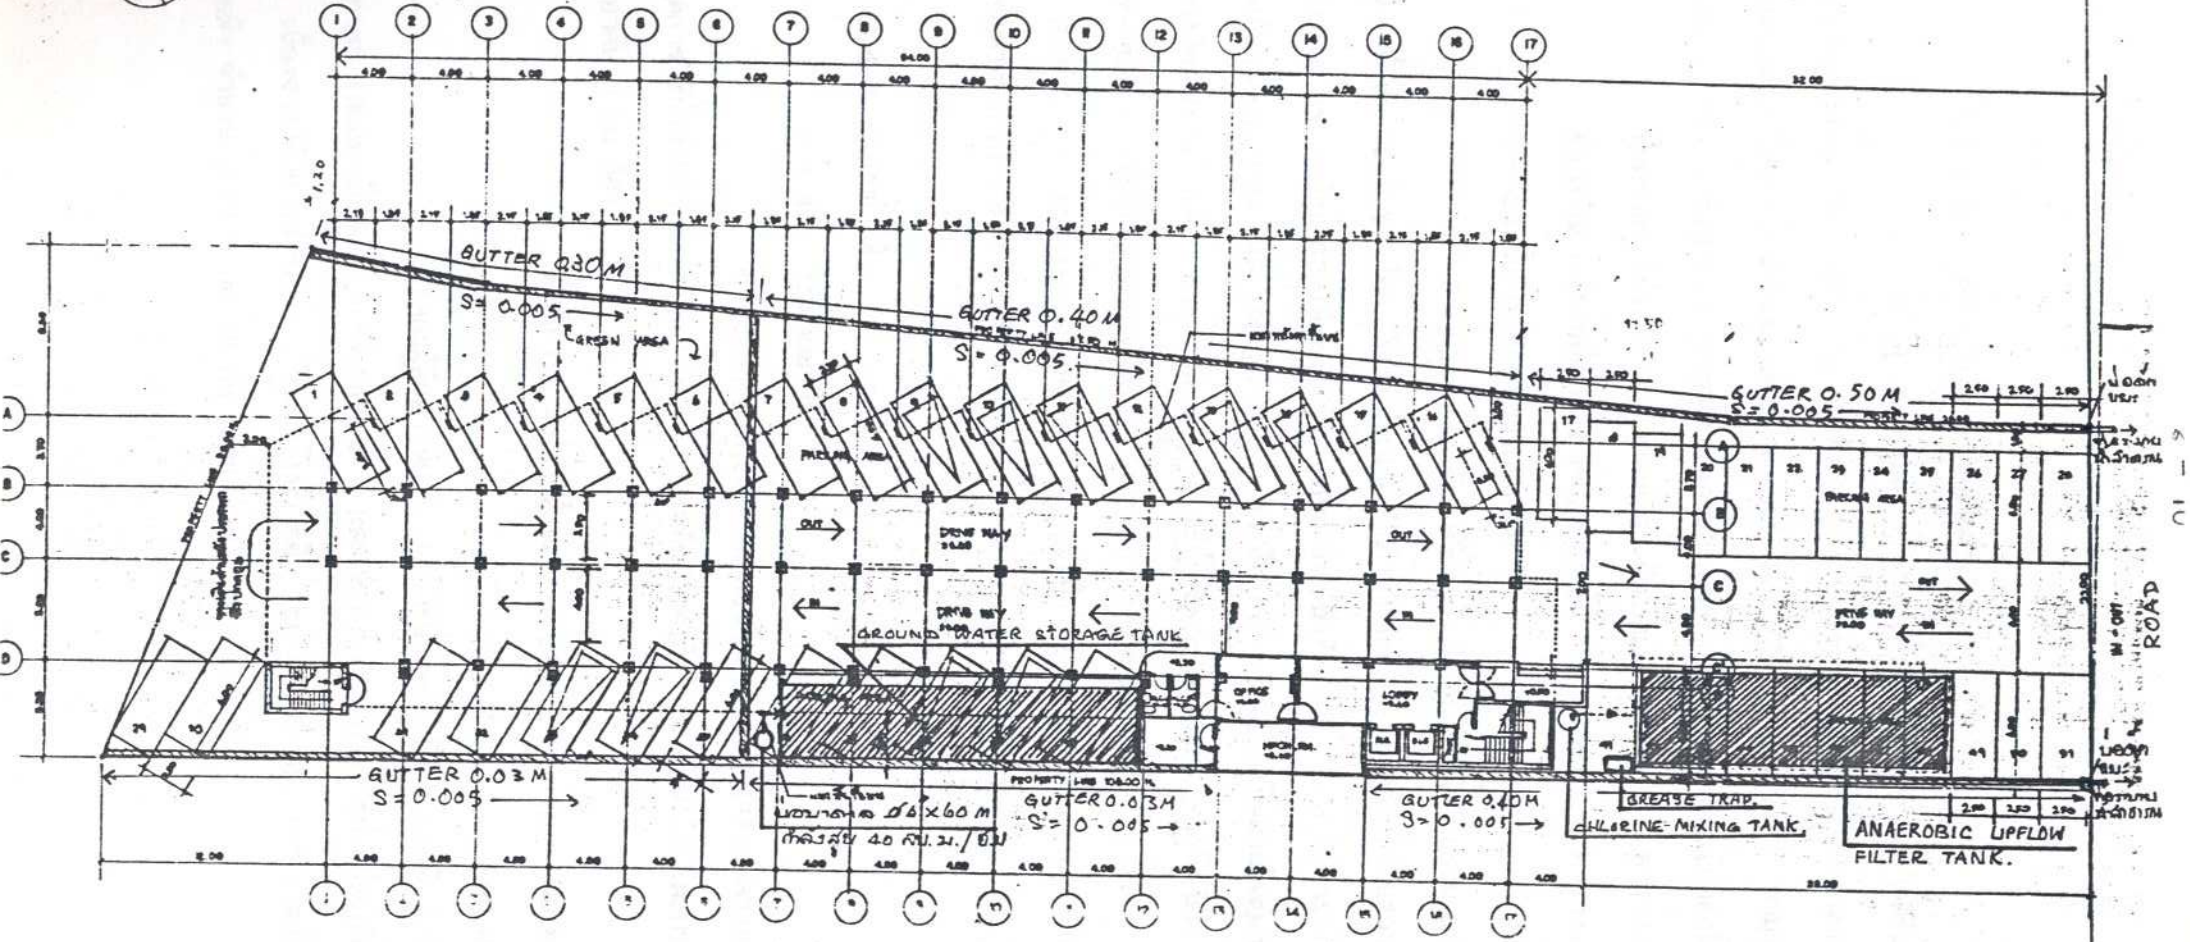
PLAN LAYOUT OF PLUMBING & SANITARY SYSTEM 2nd-13th FLOOR
